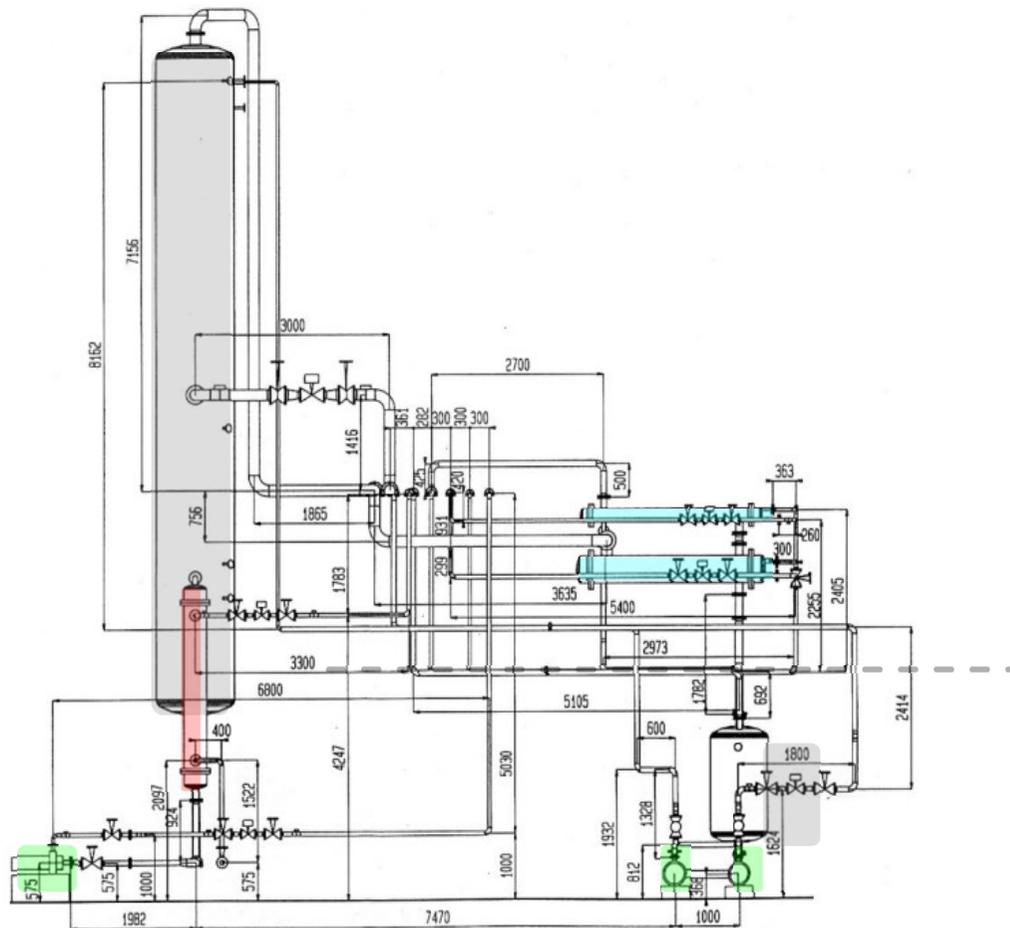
Rohrleitungsplan (Ansicht) einer Destillationsanlage
